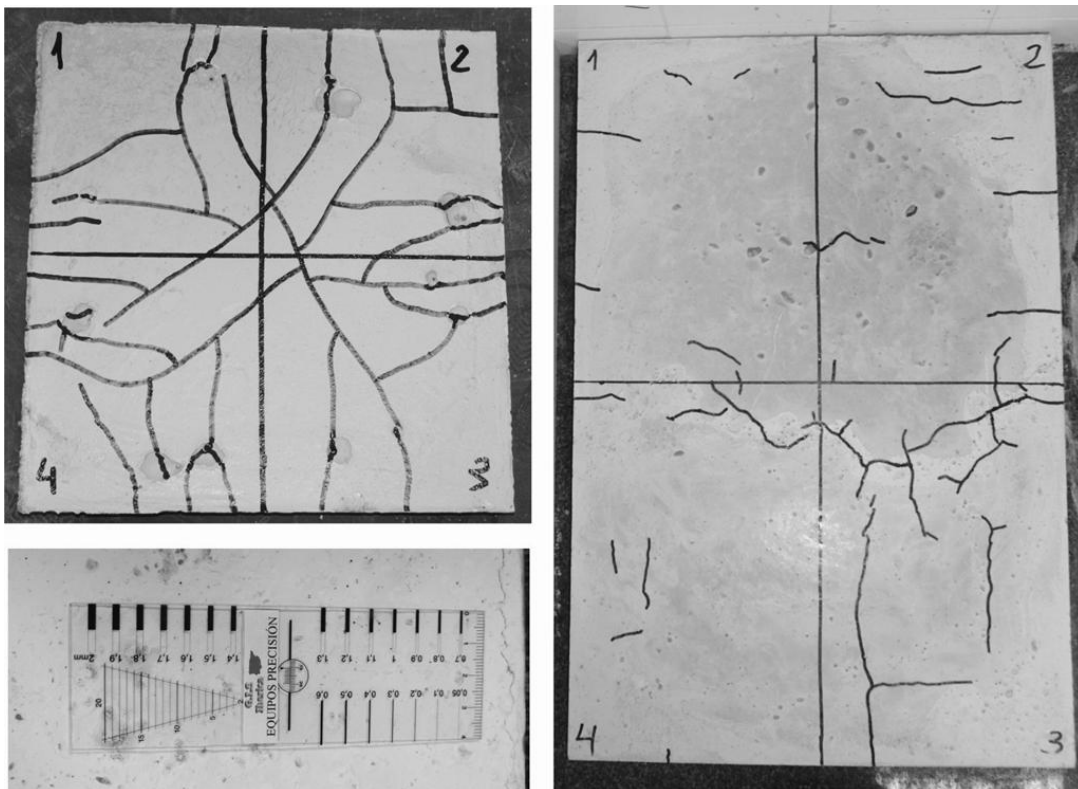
Bandeja de fisuración para pastas 40 x 40 mm (arriba izquierda), losa Kraai hormigones 90 x 60 mm (derecha) y fisurómetro.
